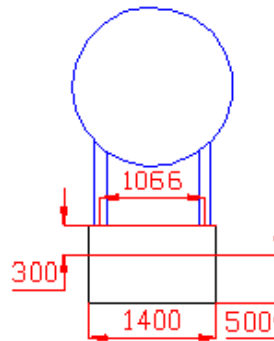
Esquema para cálculo del vuelco, vista en alzado
